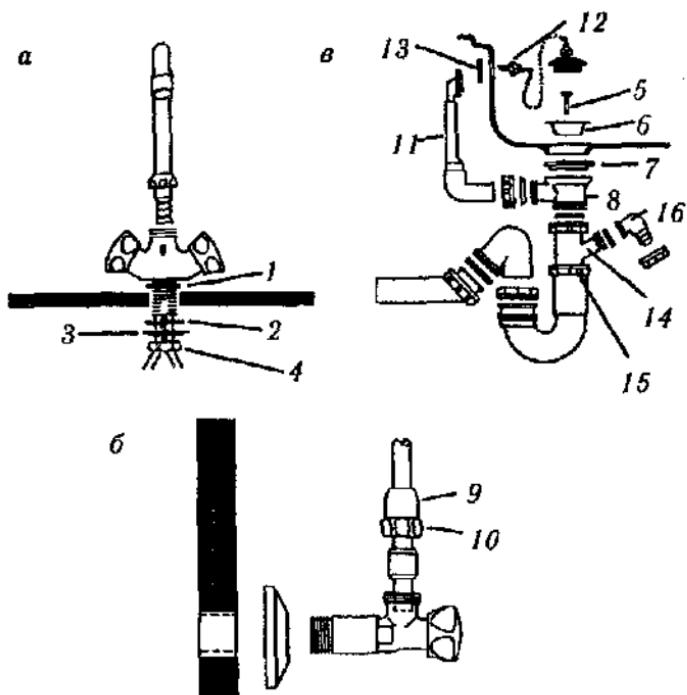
Монтаж кухонной мойки: а — монтаж смесителя; б — подключение смесителя; в — монтаж перелива, выпуска и сифона; 1 — уплотнительное кольцо; 2 — резиновая прокладка; 3 — металлическая шайба; 4 — гайка; 5 — винт; 6 — сеть выпуска; 7 — прокладка; 8 — тройник; 9 — зажимной конус; 10 — гайка; 11 — перелив; 12 — винт; 13 — прокладка; 14 — тройник сифона; 15 — гайка; 16 — угловой наконечник.
